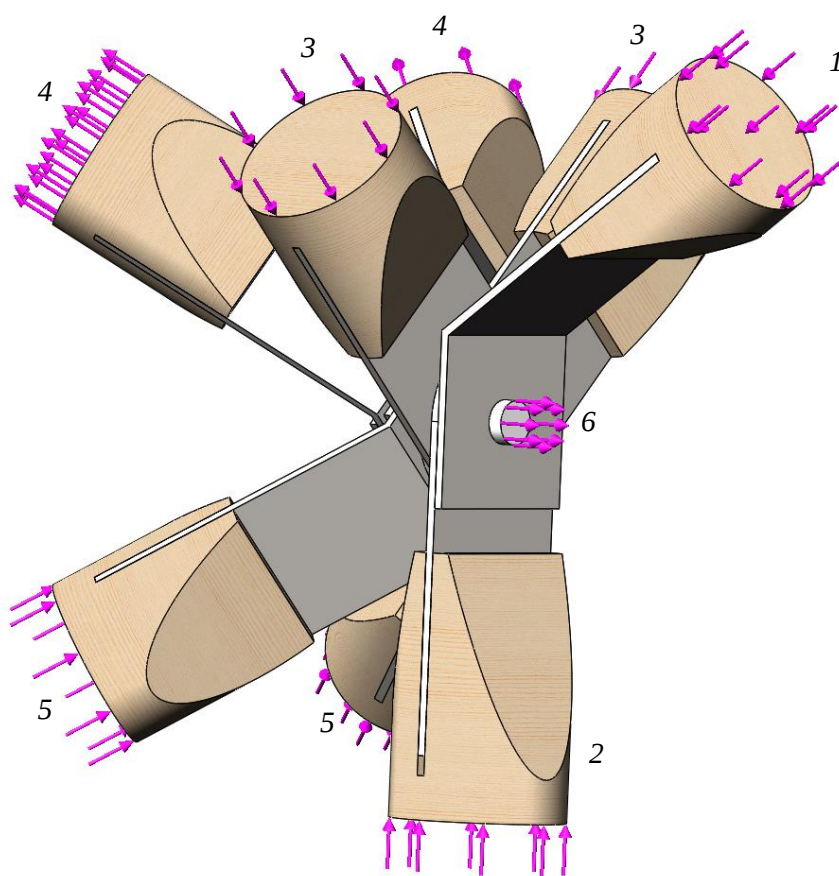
Расчетная схема наиболее нагруженного узла конструкции:
